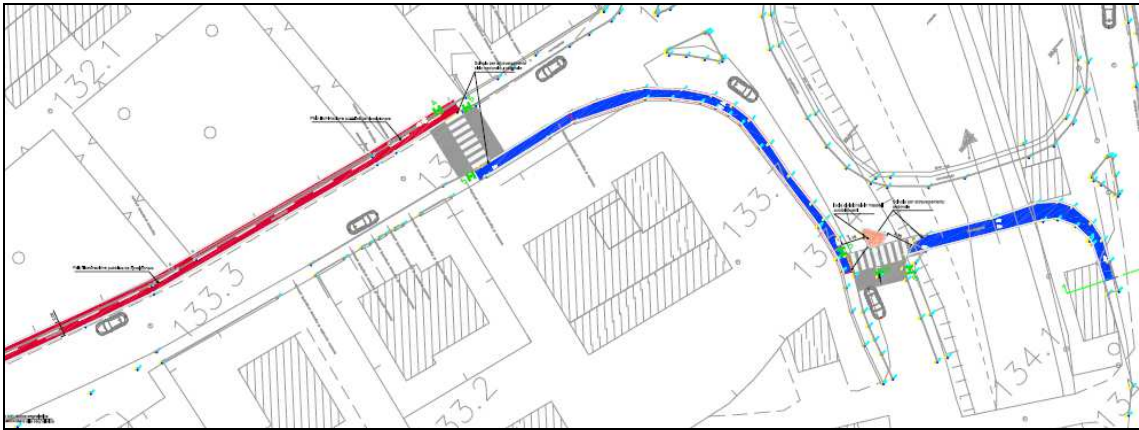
Tratto compreso nell'intorno dell'intersezione di Via del Ponte alle Forche con la SP13
